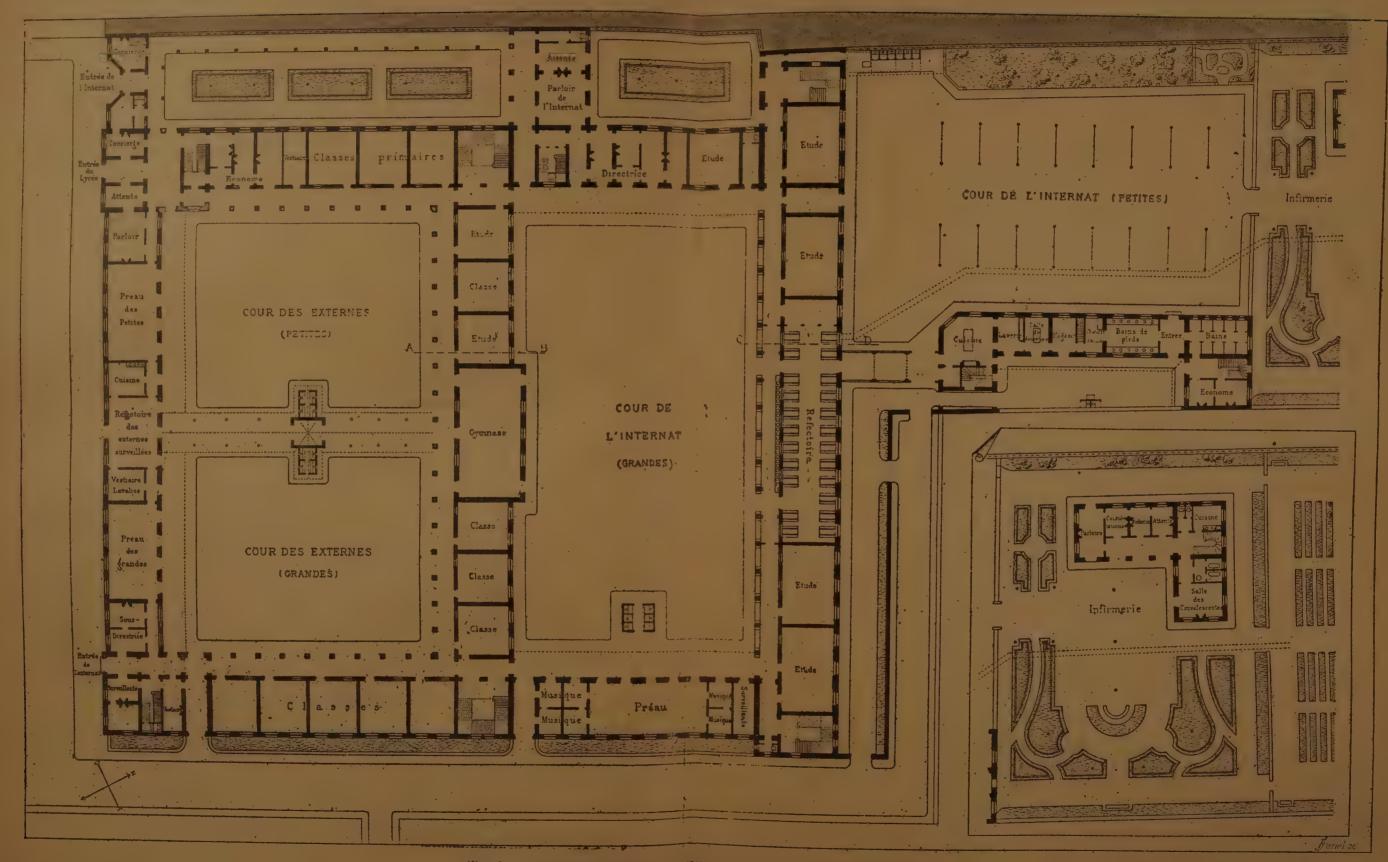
Lycér de jeunes filles, a montauban, plan du rez-de-chaussée.
